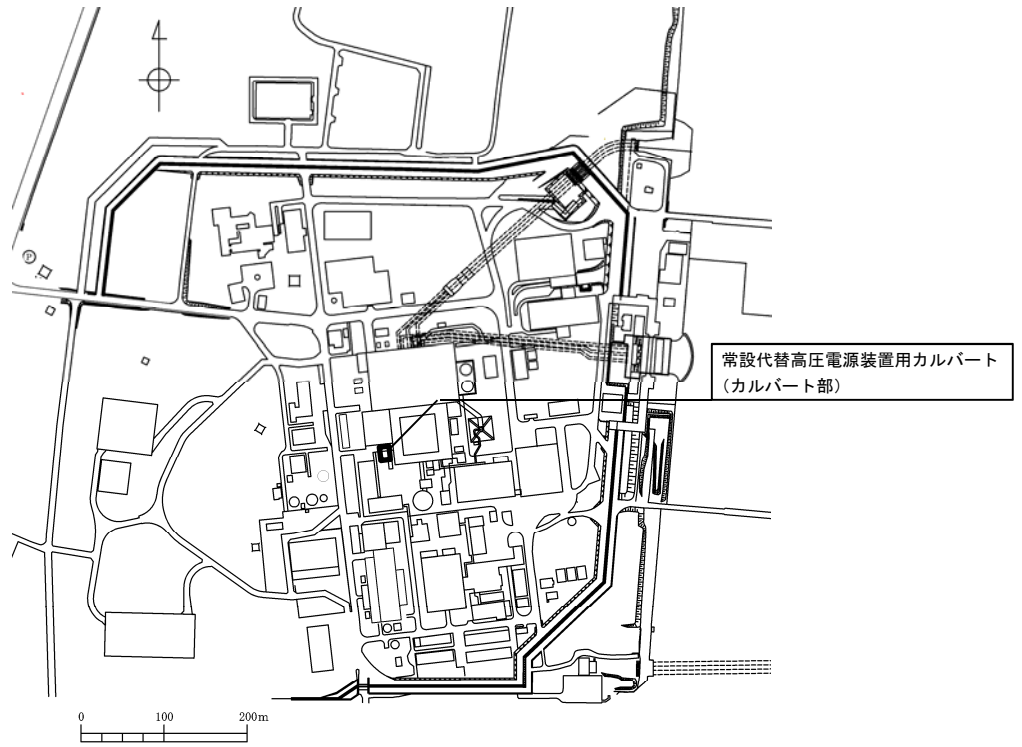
(1) カルバートの平面配置図 (全体平面図)
